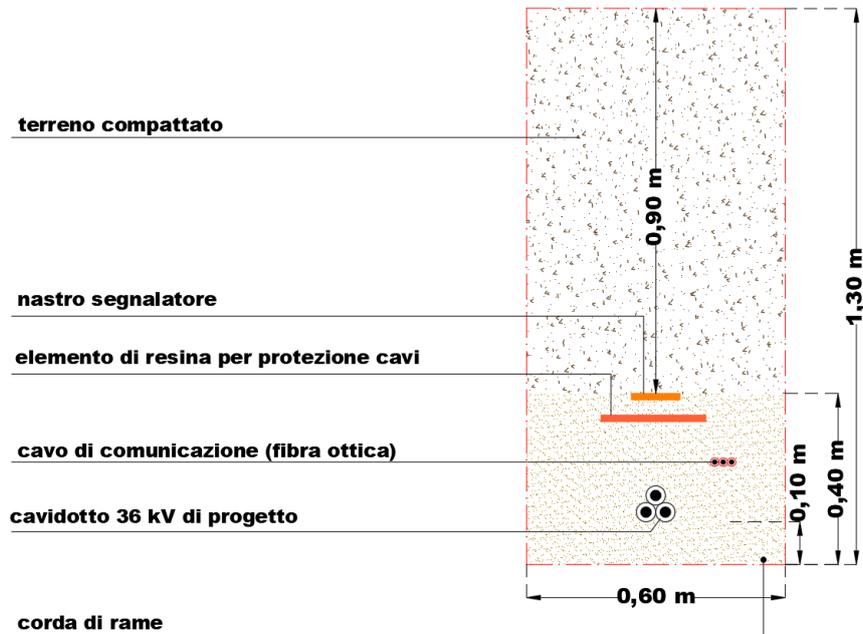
Sezione Cavidotto Singola Terna su Terreno
